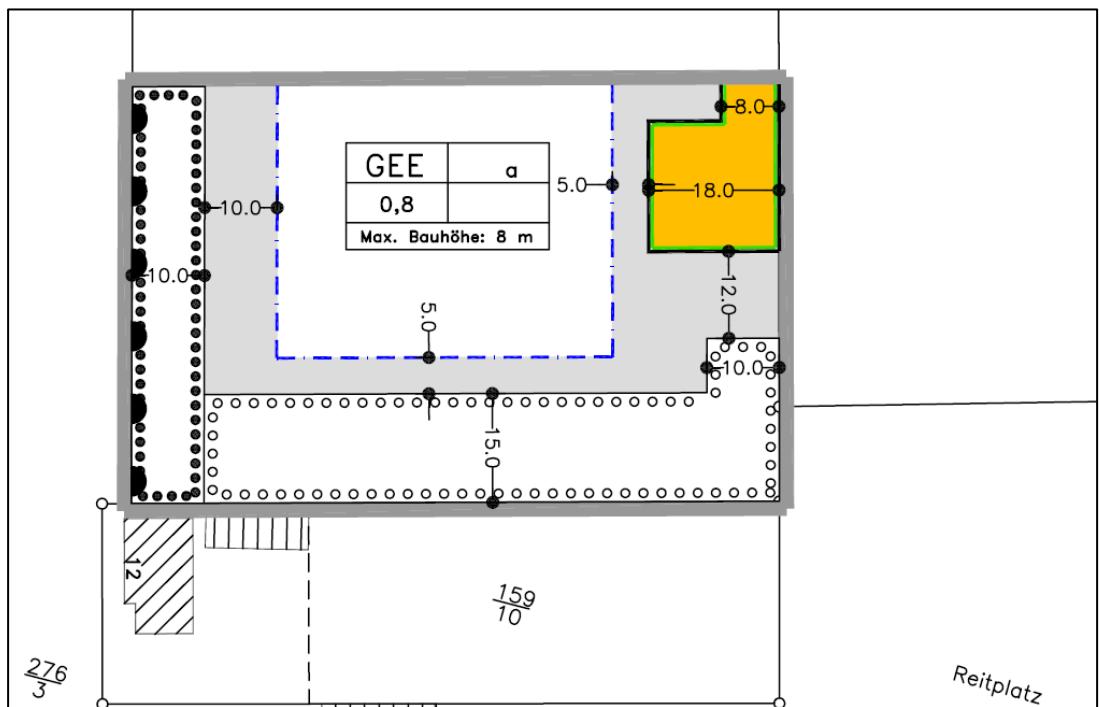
Bebauungsplan Nr. 28 "Gewerbegebiet Kirchdamm-Seehausen", 1. Änderung
